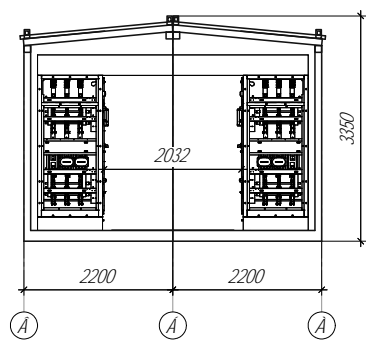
Модульное здание для NXAIR SIEMENS
